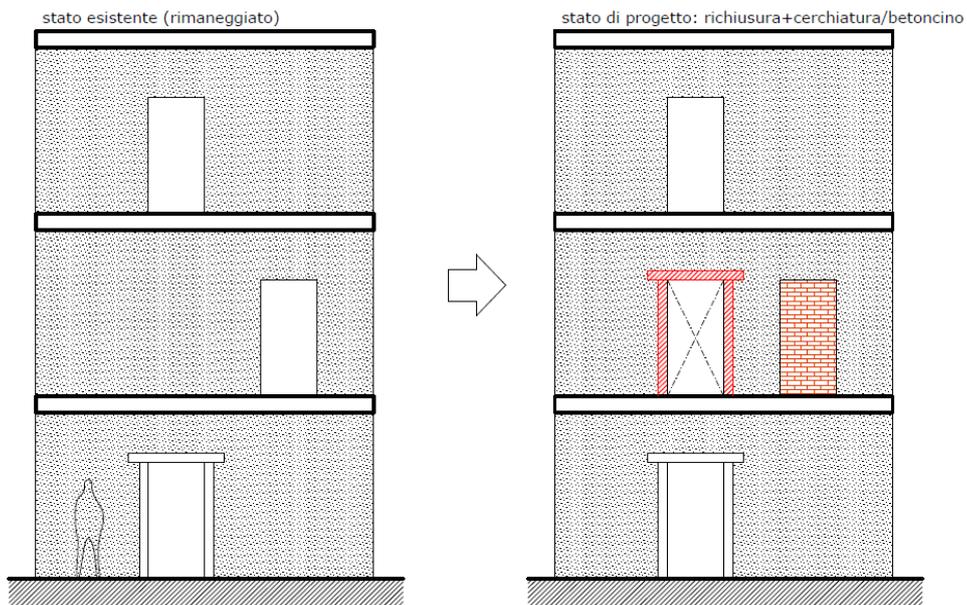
Inserimento di vano porta in riallineamento di aperture su pareti rimaneggiate in passato
